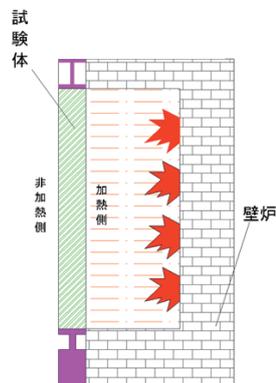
壁炉に試験体を取り付けた断面の模式図
